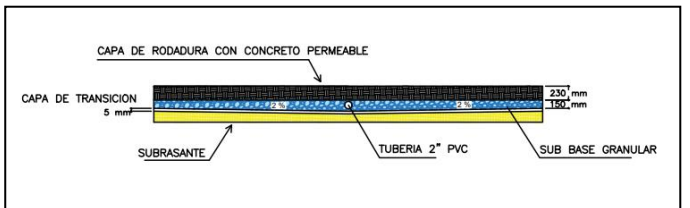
Propuesta de pavimento permeable final con conducción de aguas según Catálogo Estructural del MTC
